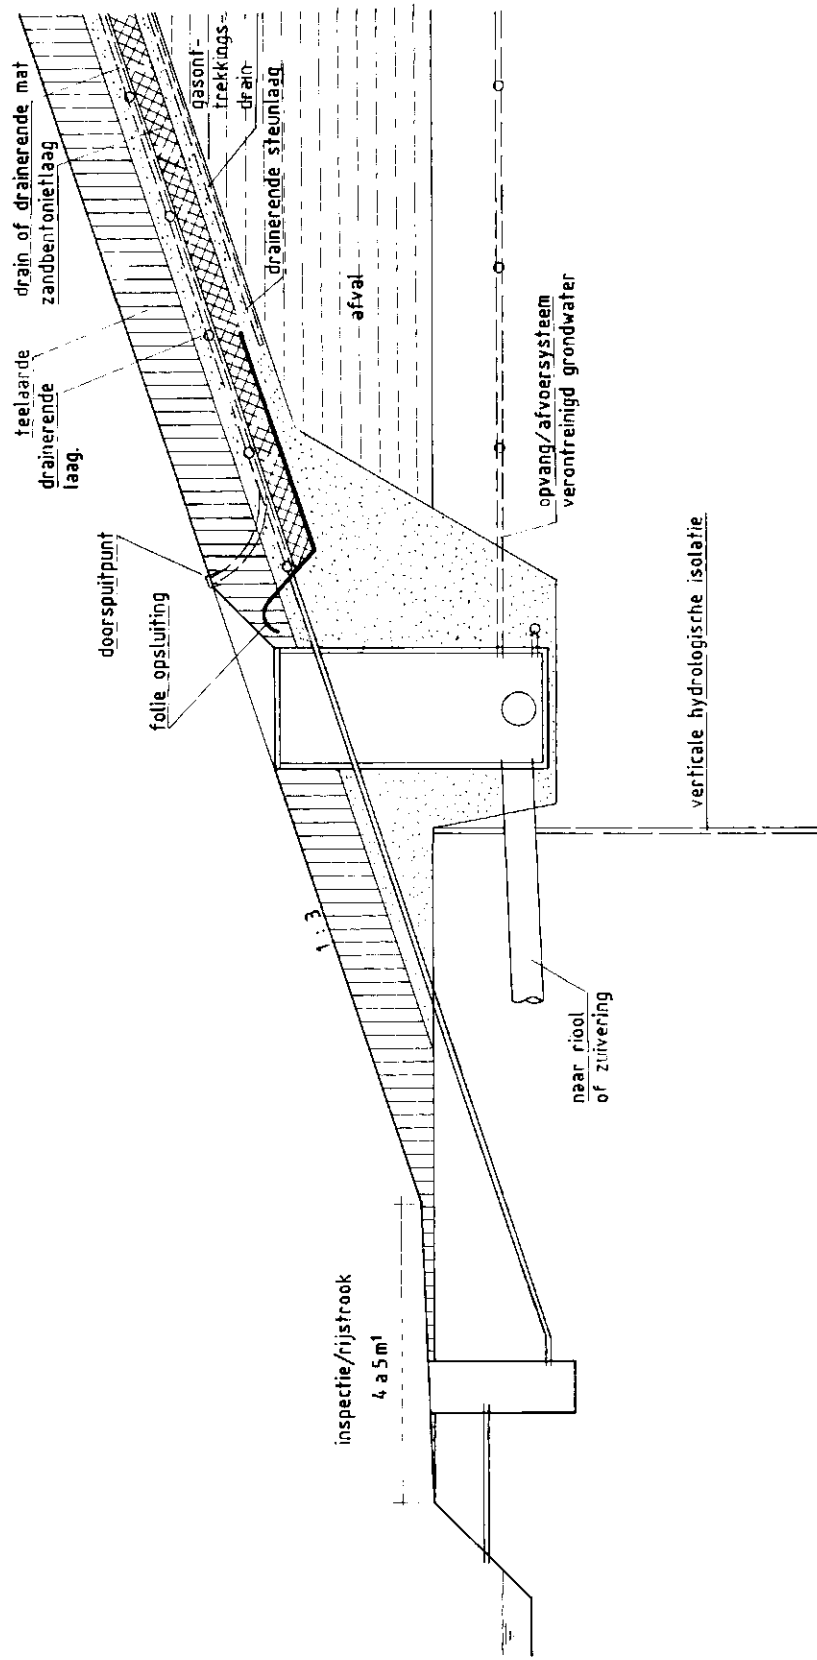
Voorbeeld van een teenconstructie met bovenafdichting bij een bestaand afvalstort zonder onderafdichting.
